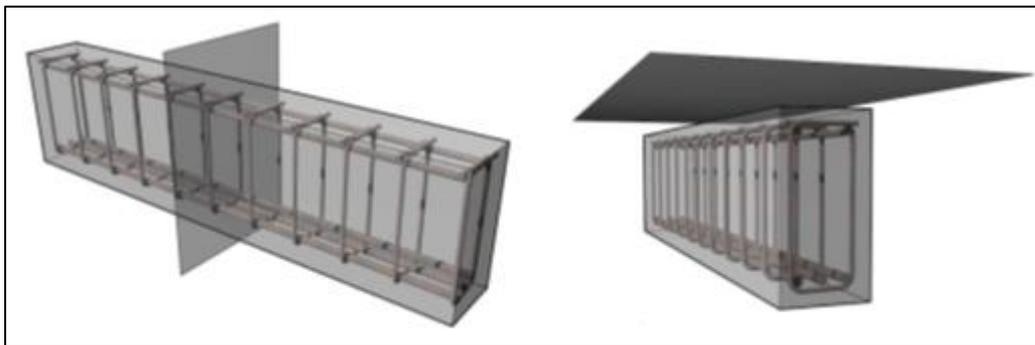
Plano de corte e alçado superior demonstrativos das exigências impostas para os desenhos de construção.
